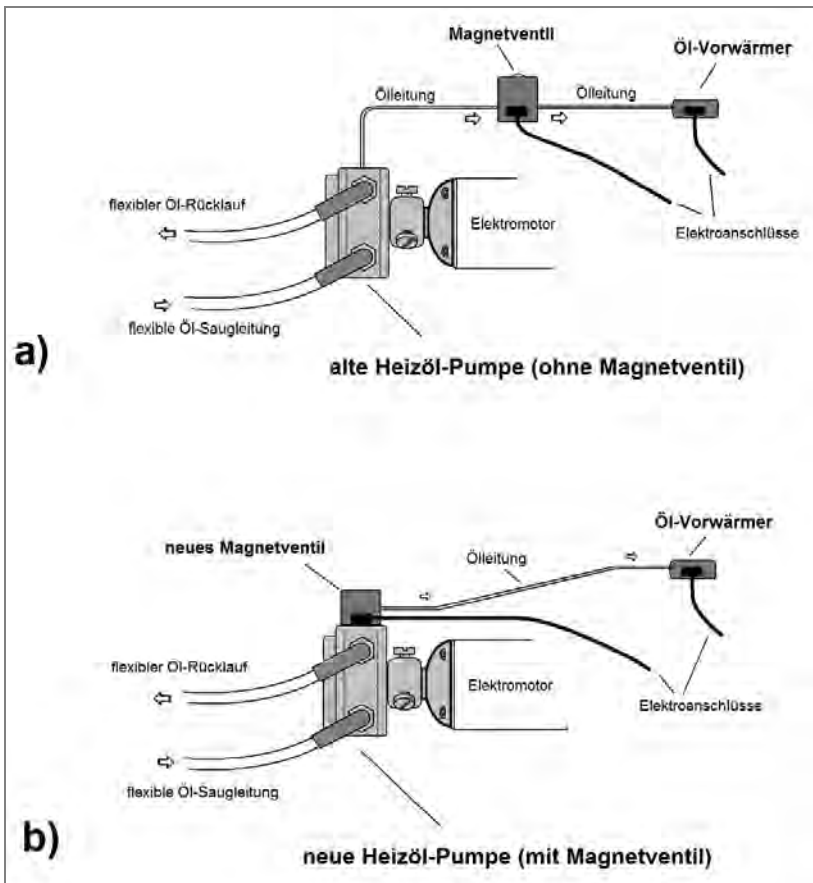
Wird anstelle einer Ölpumpe ohne Magnetventil eine neue Ölpumpe mit integriertem Magnetventil „notgedrungen“ eingesetzt, muss (bzw. kann) das alte Magnetventil demontiert werden.
